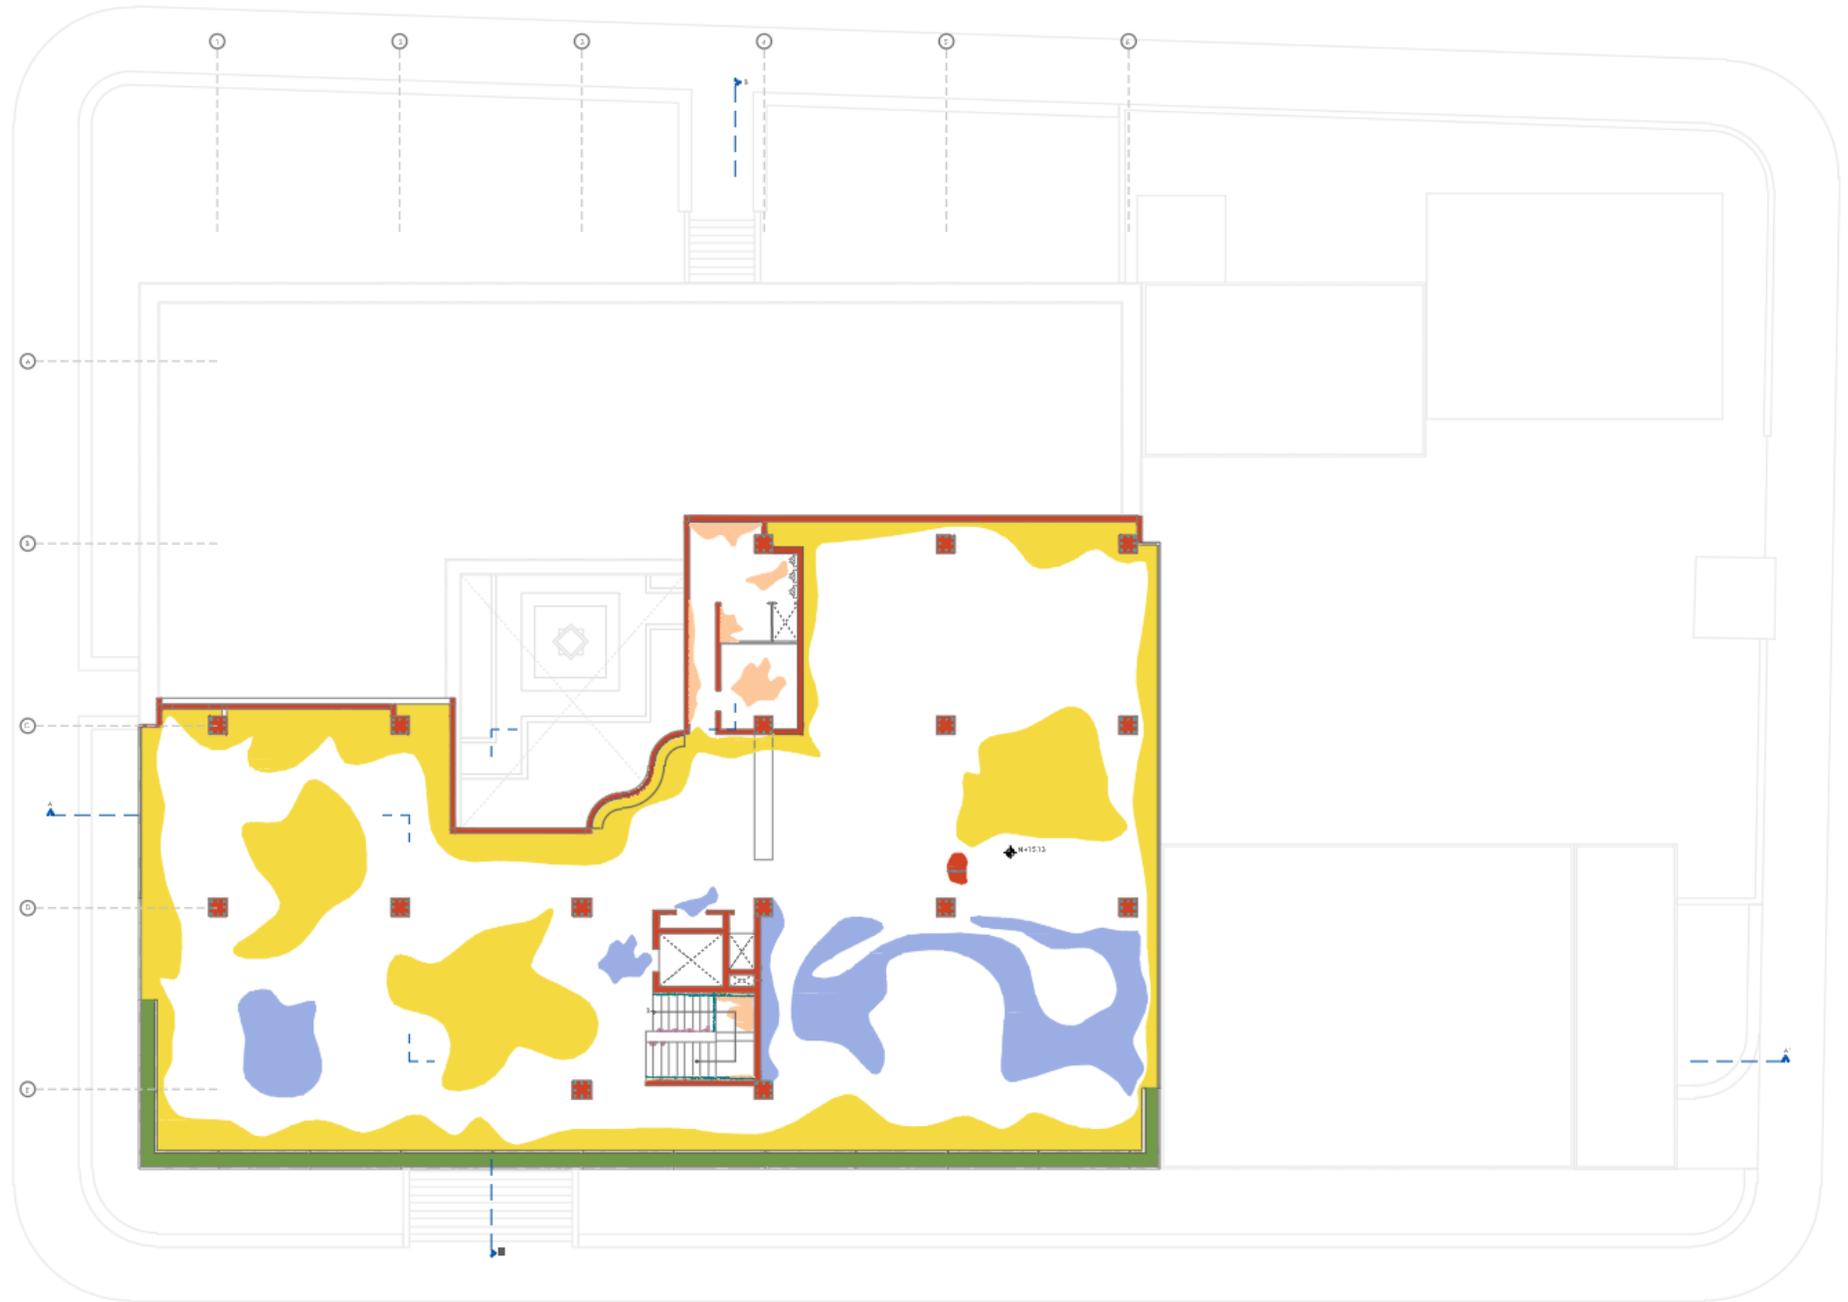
| Patologías de planta alta 3. Elaboración propia, 2021.
